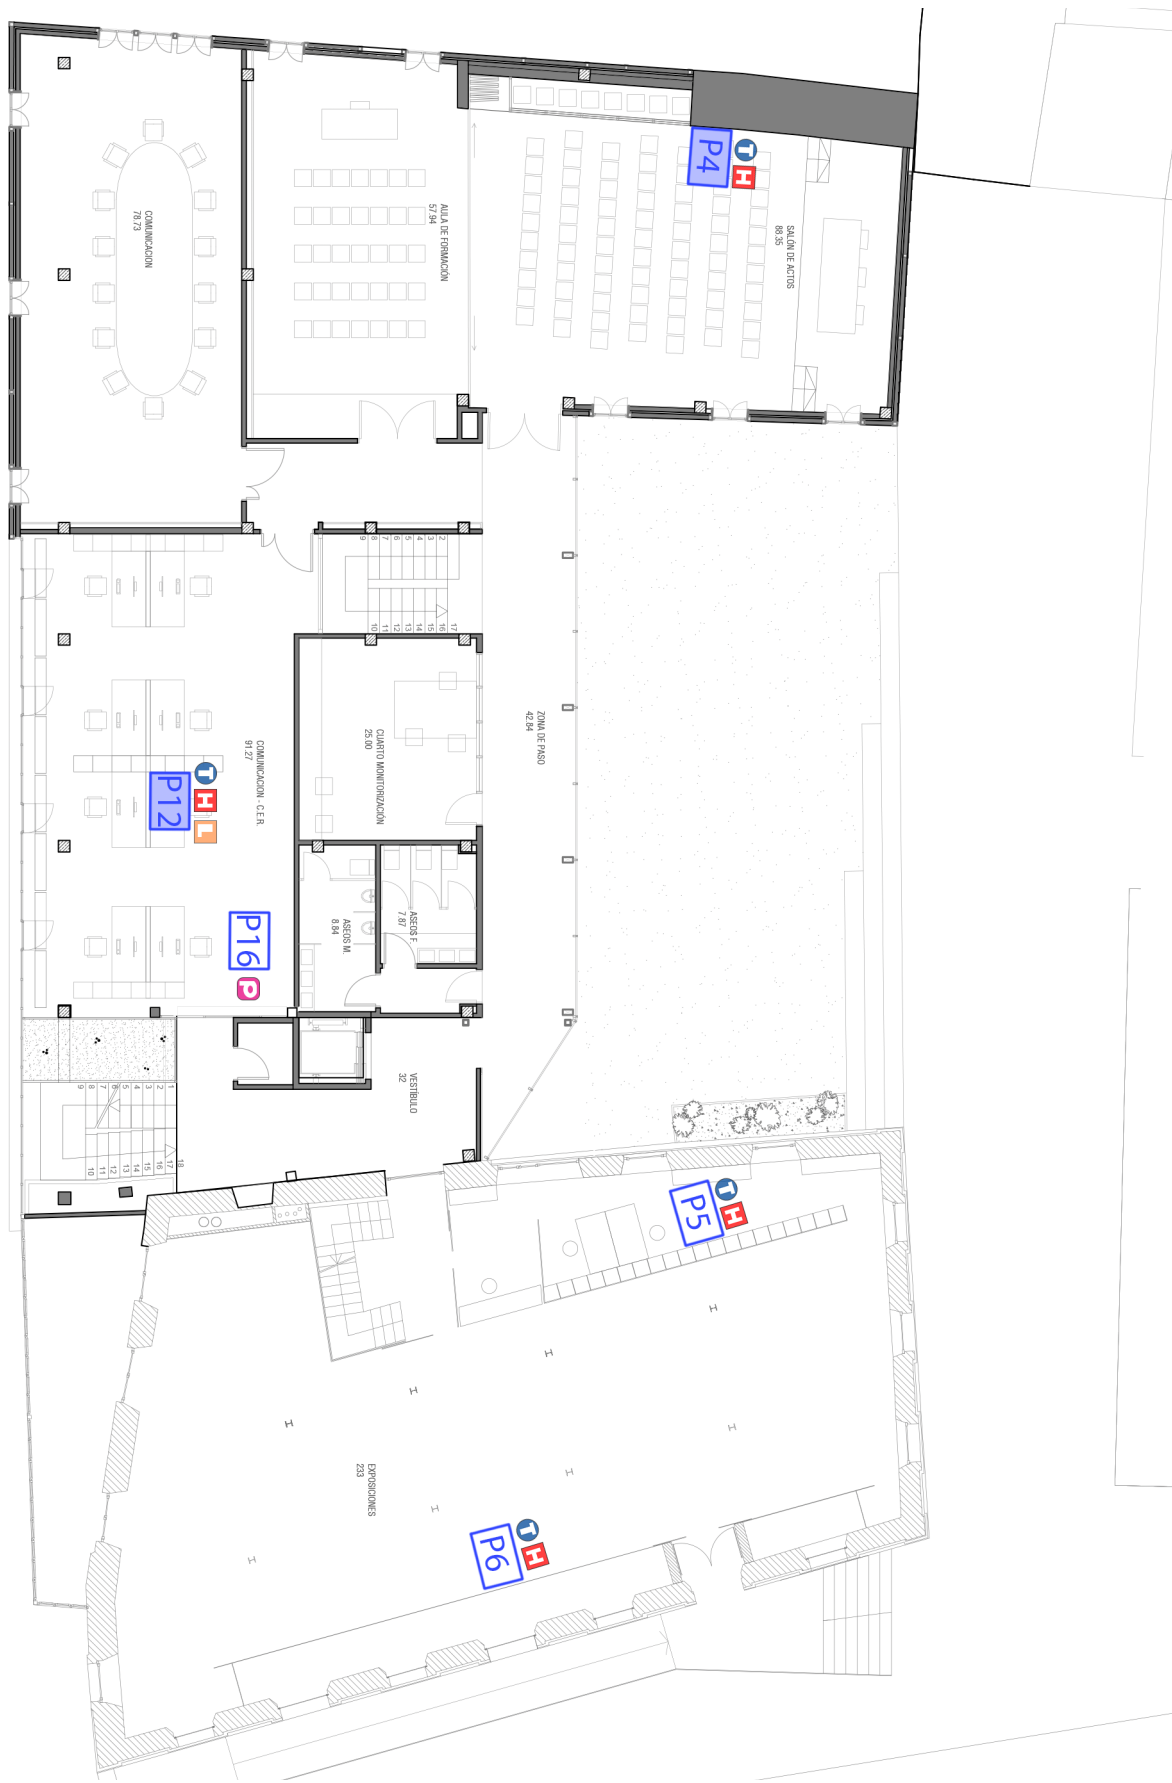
Ubicación de los sensores. Planta baja E 1:200
